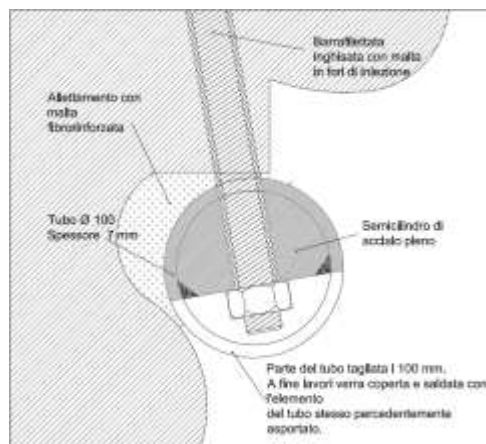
Dettaglio di progetto del collegamento dell'anello strutturale alla muratura
